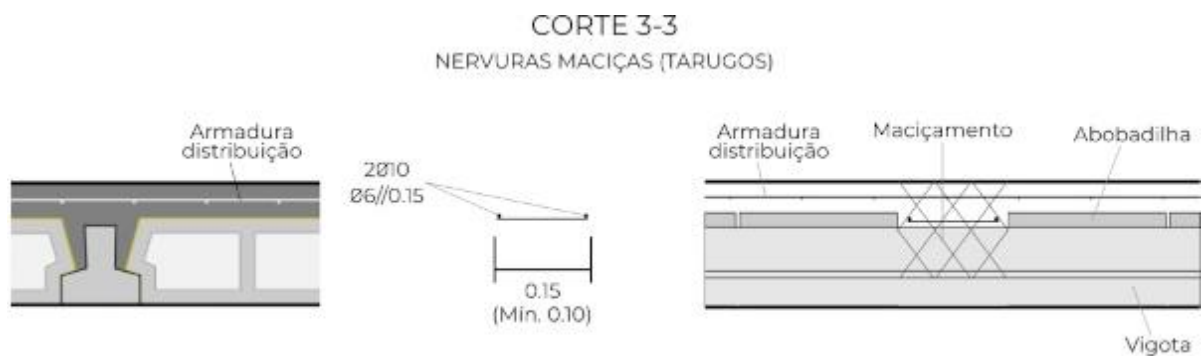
Nervuras transversais (Tarugos) em pavimentos com espessura total até 200 mm
